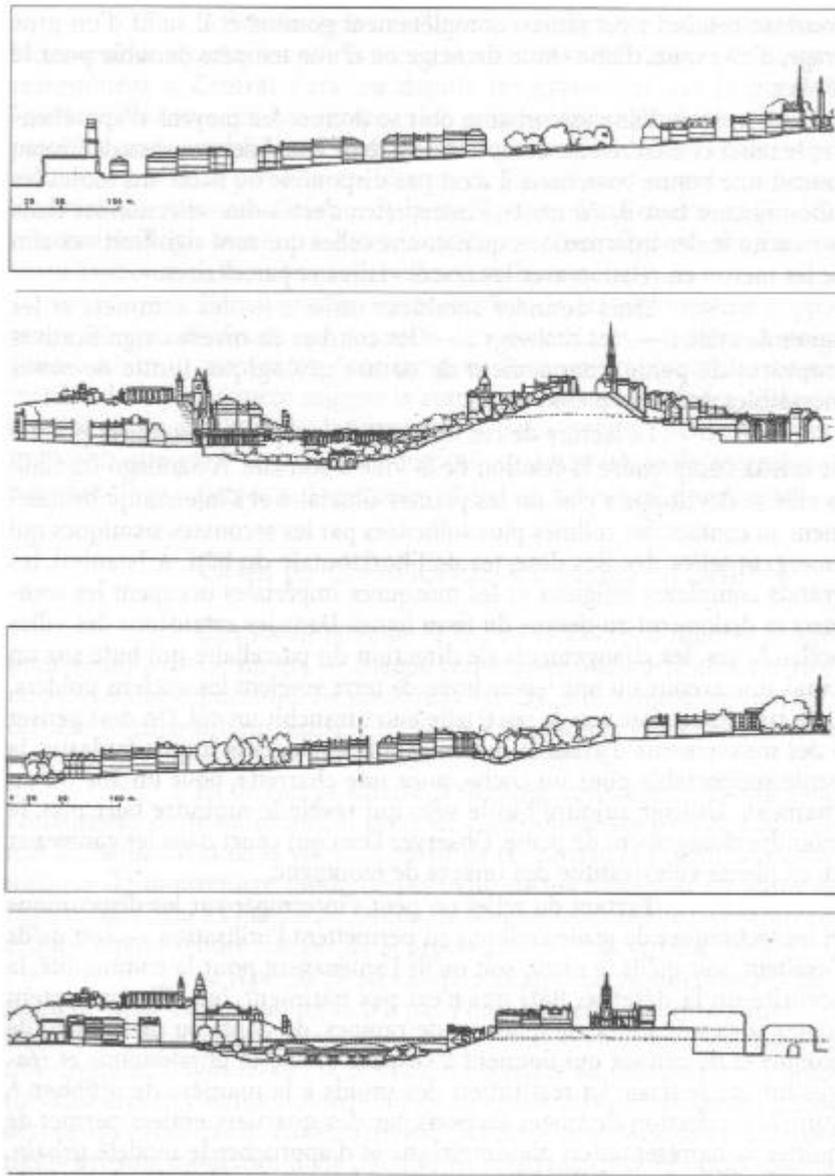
LA COUPE ET LA VILLE, SECTIONS SUR LA VILLE D'EDIMBURG,
